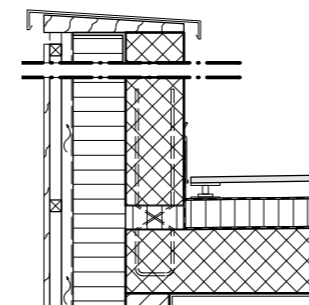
DECKENDETAIL ERDGESCHOSS
